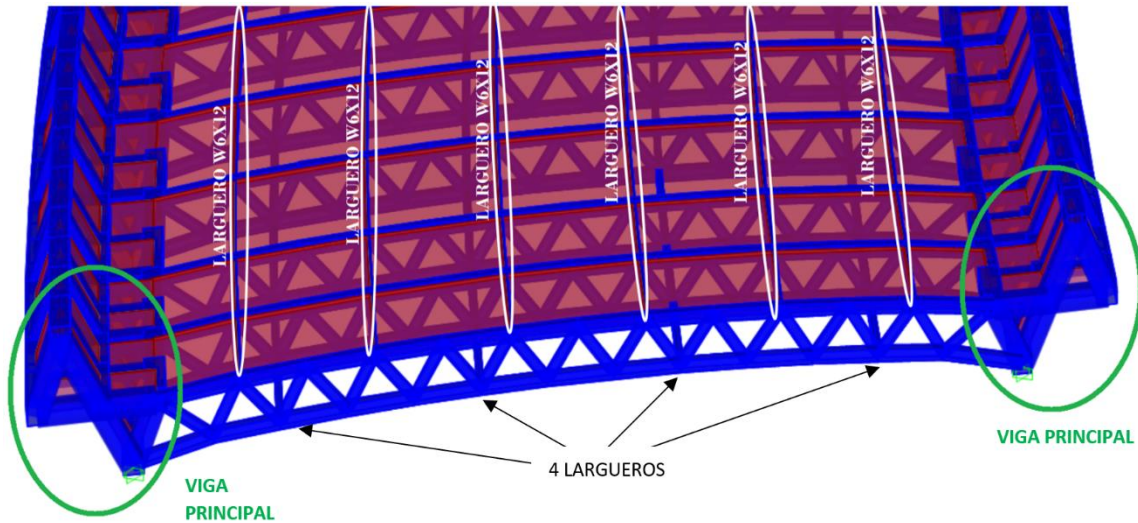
Ubicación de vigas en dirección longitudinal del puente (vista de sección de losacero)
